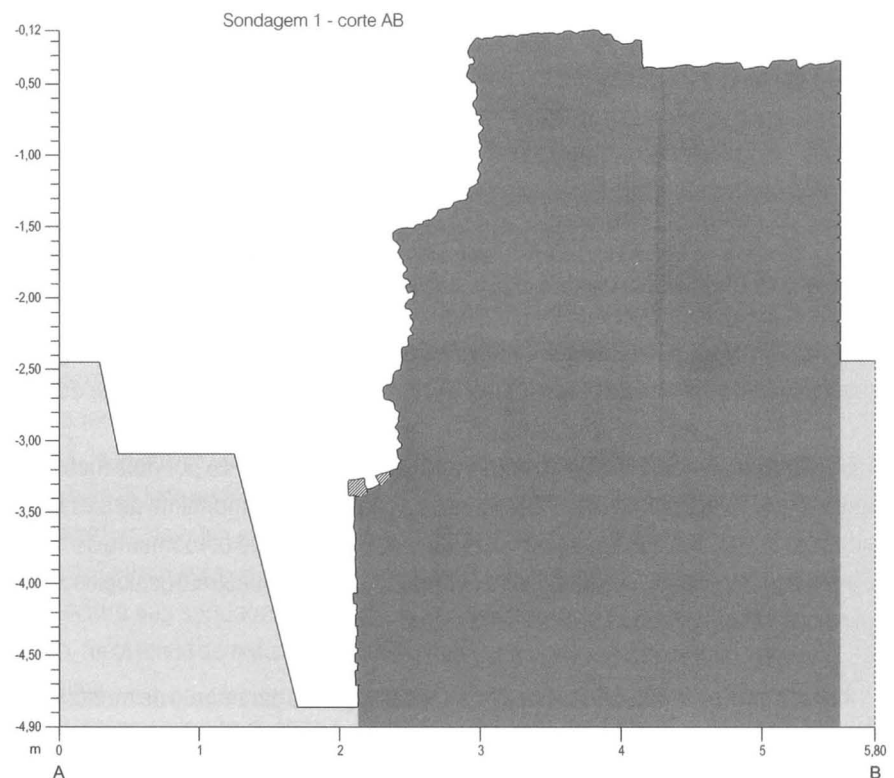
Barragem do Álamo. Corte AB da sondagem 1.
